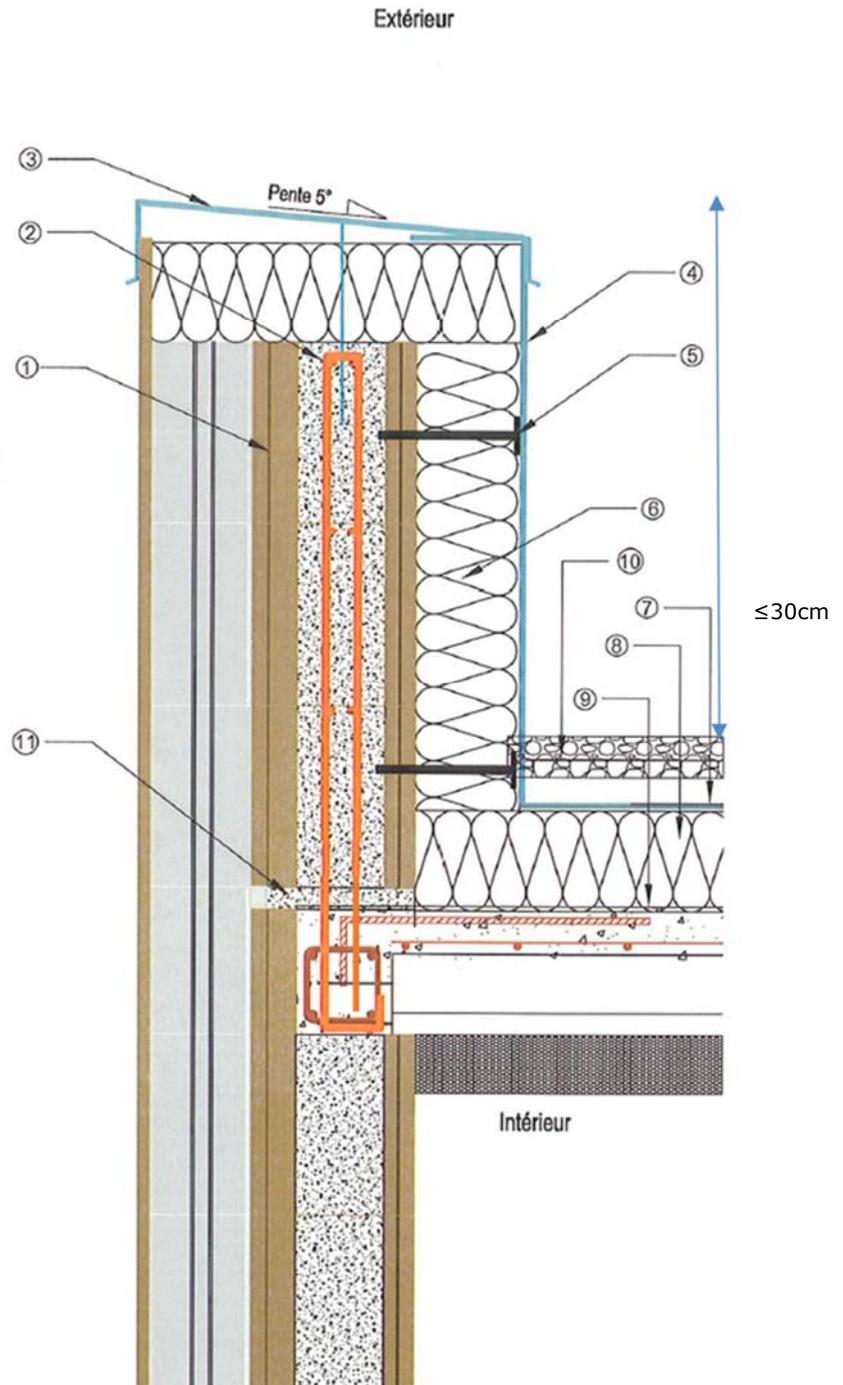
Traitement des acrotères bas (acrotères dont la hauteur au-dessus de la protection de l'étanchéité ne dépasse pas 300 mm)
